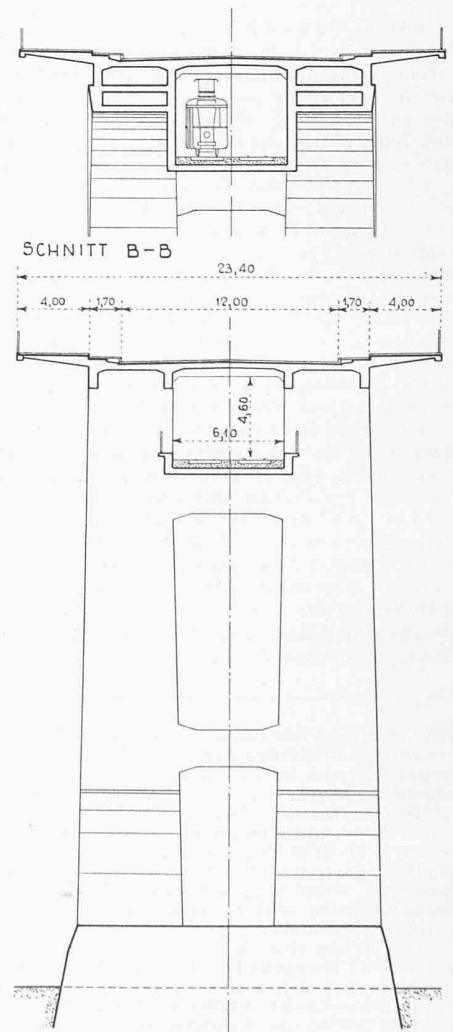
Kirchenfeldbrücke mit Tram unter der Strassenfahrbahn, Schnitte 1:400
